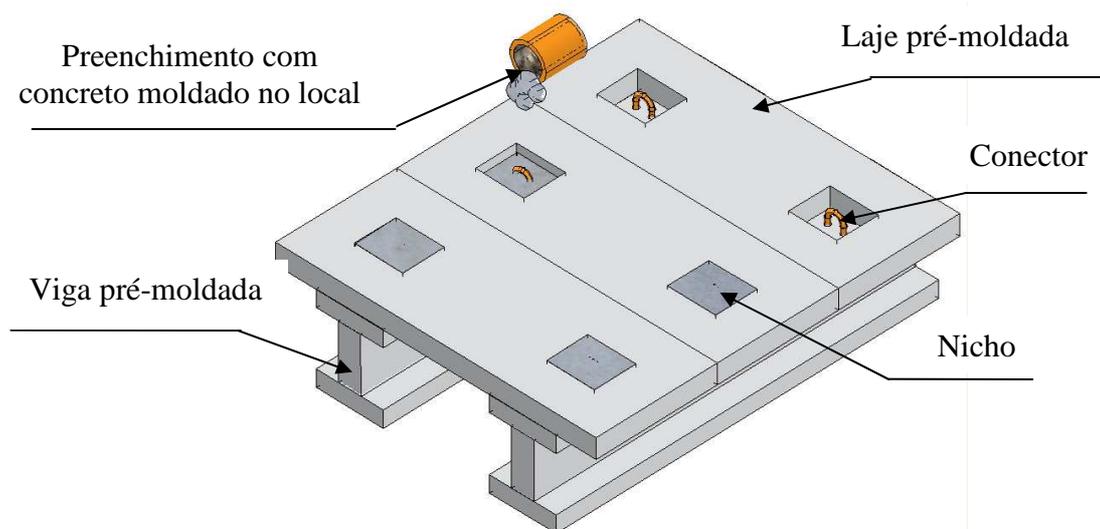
Associação entre viga e laje pré-moldadas. Baseado em Araújo (2002)
